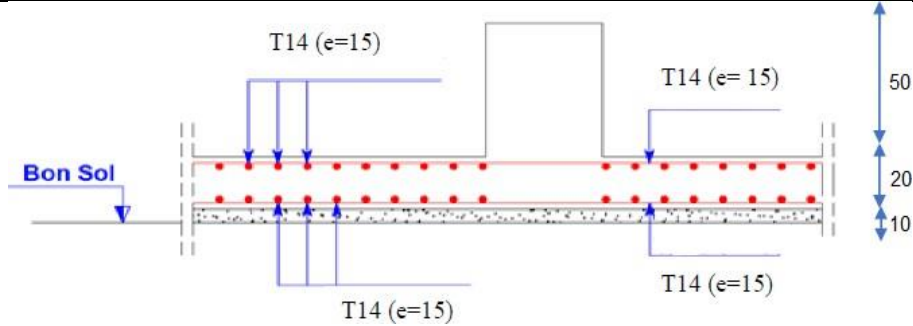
Dessin de la de ferrailage Dalle de radier
